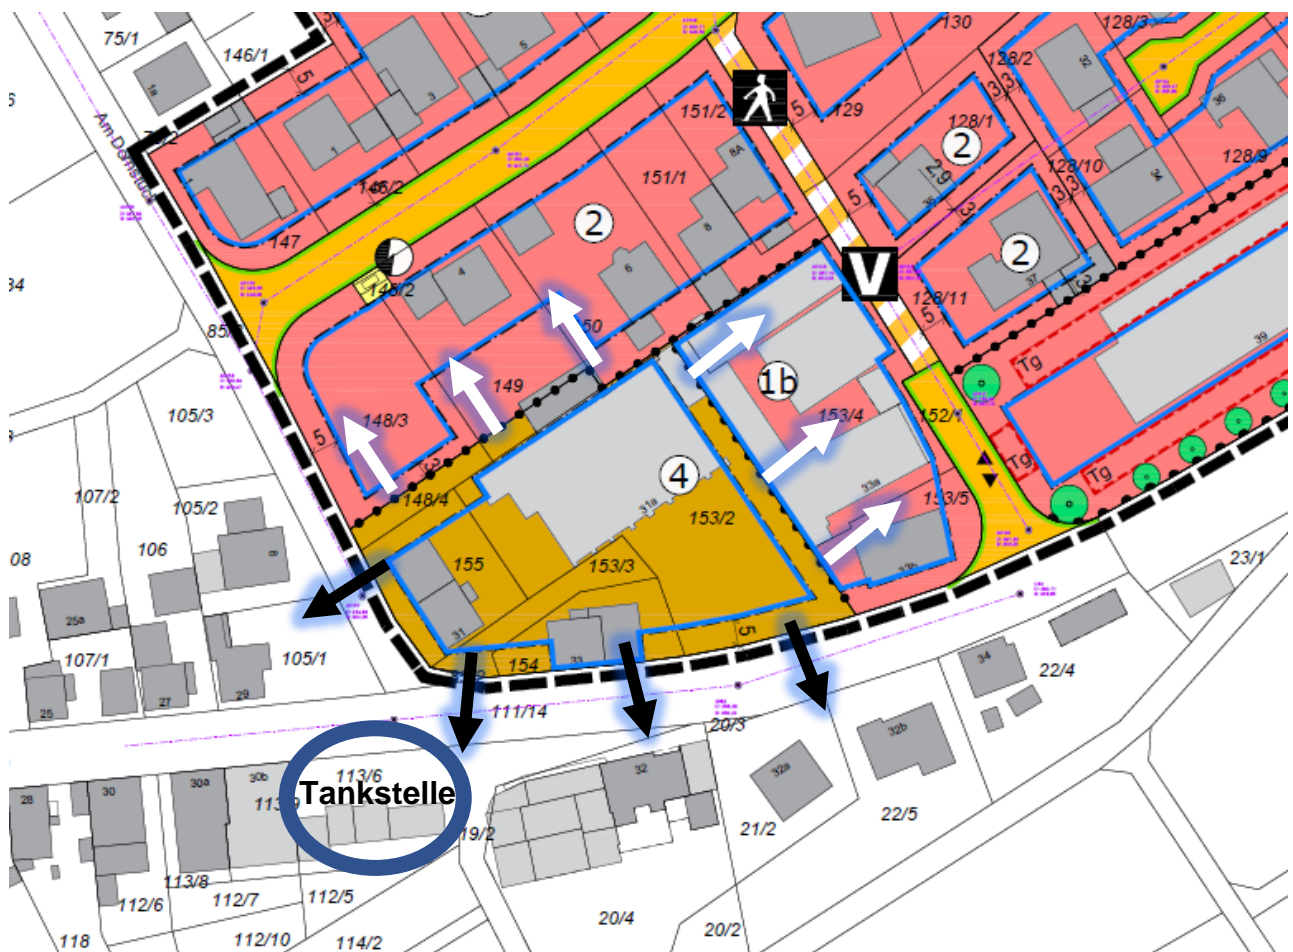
Ausschnitt B-Plan mit Mischgebietsfläche
